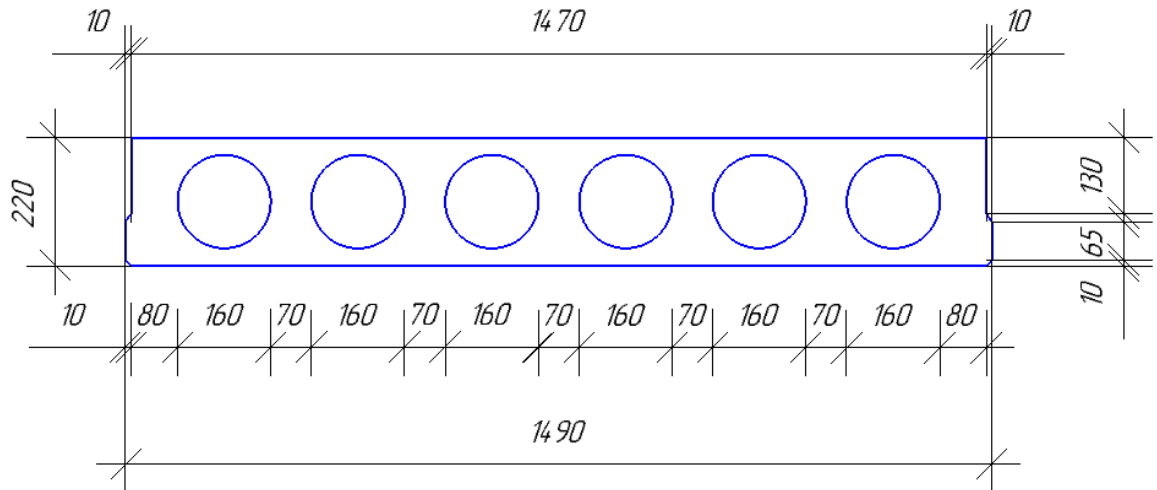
Геометрические характеристики поперечного сечения панели.
